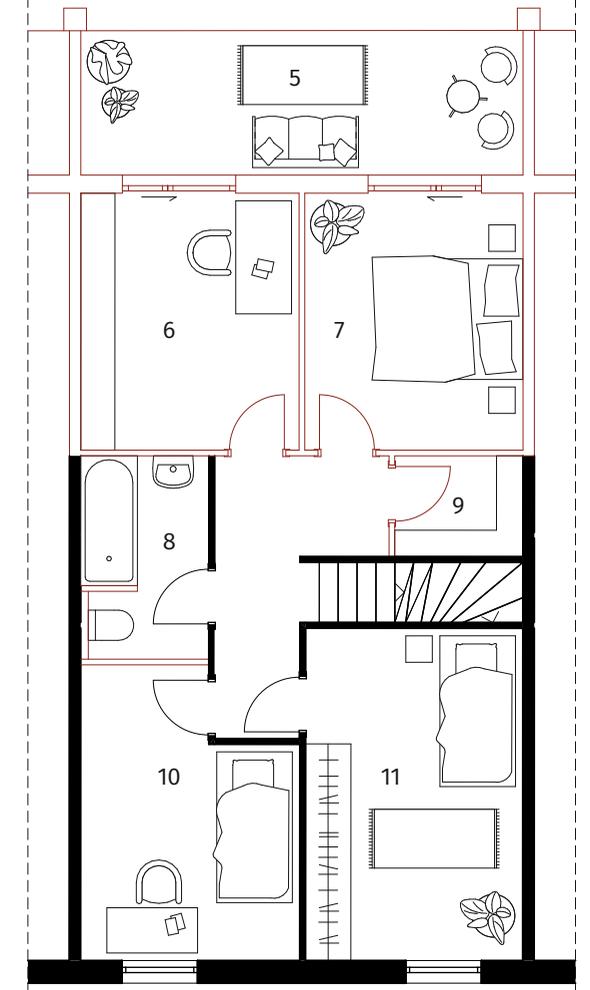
Grundriss Untergeschoss. M 1 : 100
